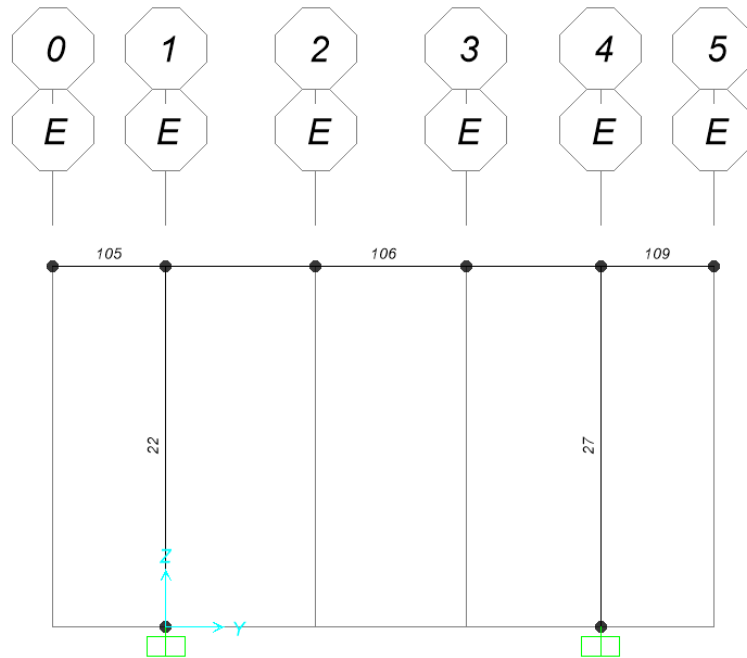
Vista in sezione modello struttura in elevazione –Filo E - numerazione elementi frame e joint
